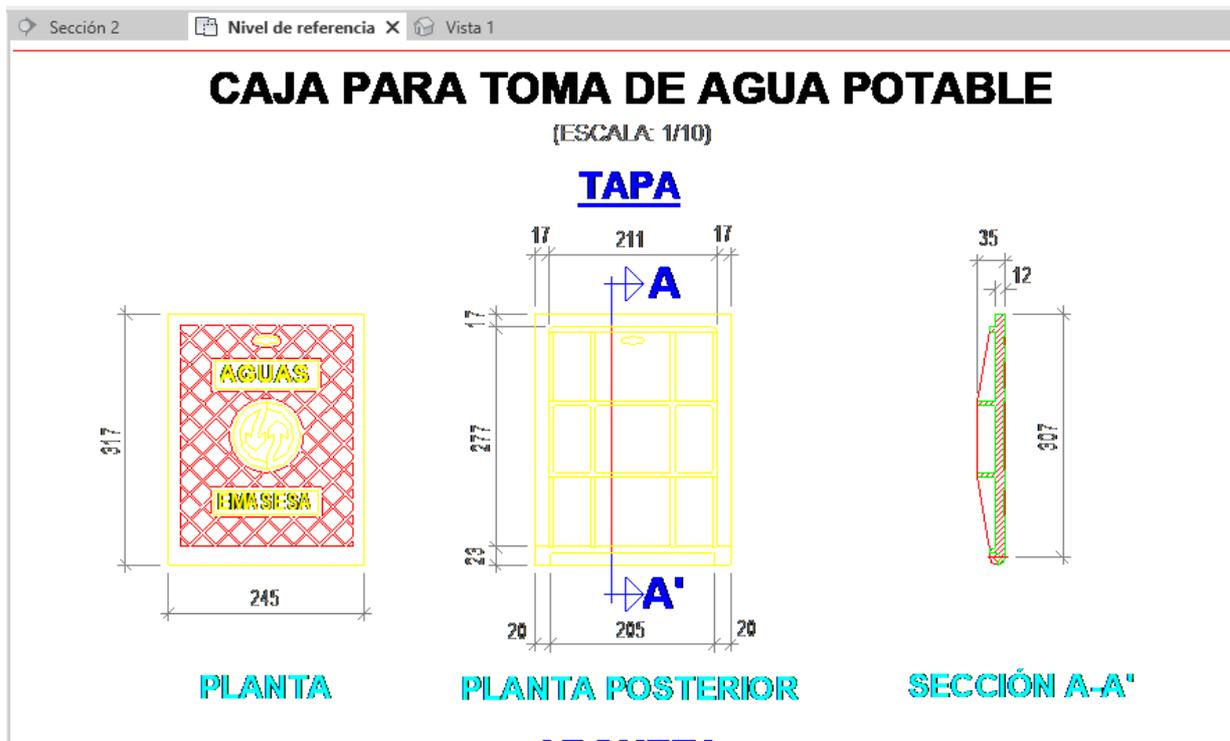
Restricciones modificadas de la arqueta en planta.
